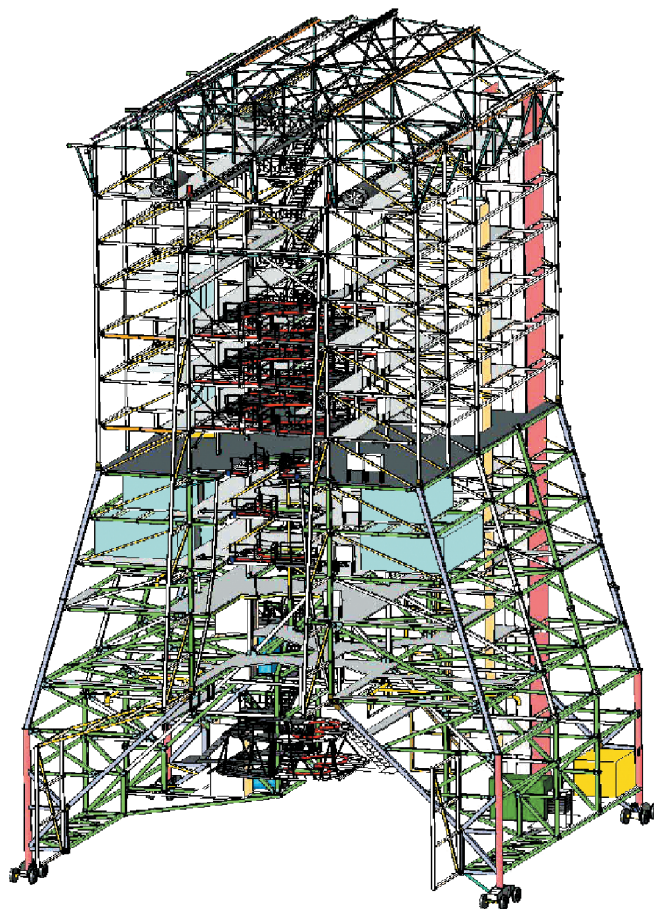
Общий вид металлоконструкции мобильной башни обслуживания
